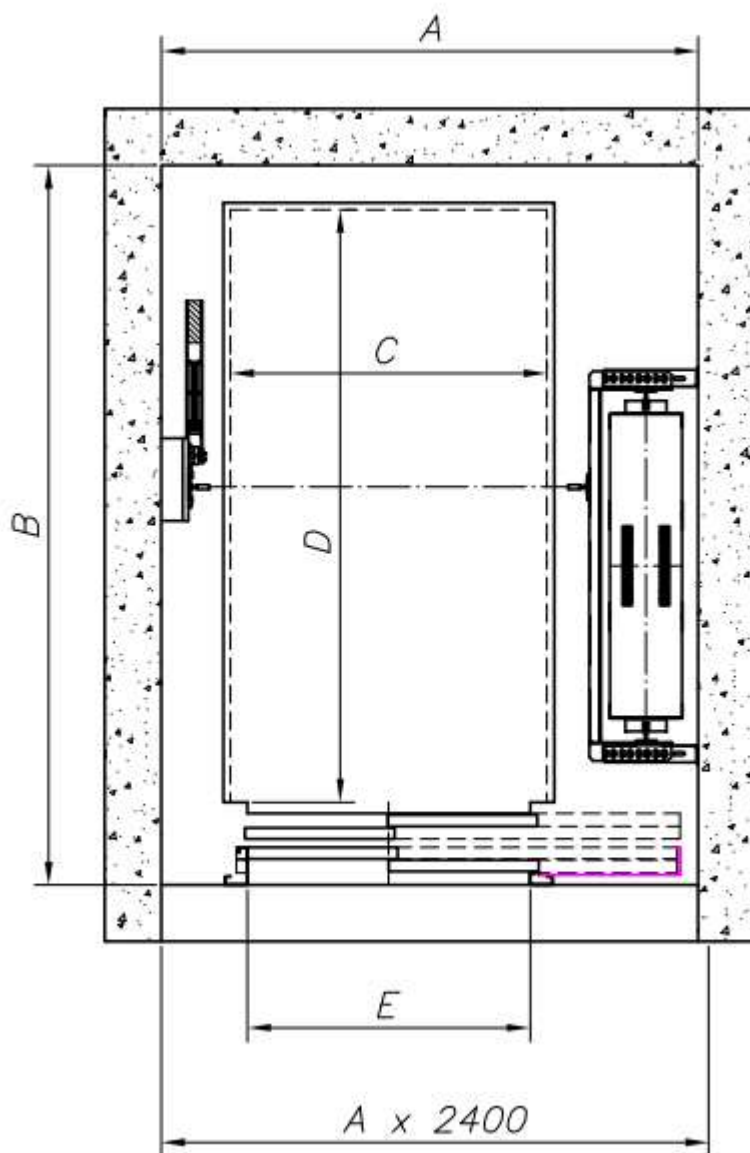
Схема будівельного завдання на ліфт у плані
